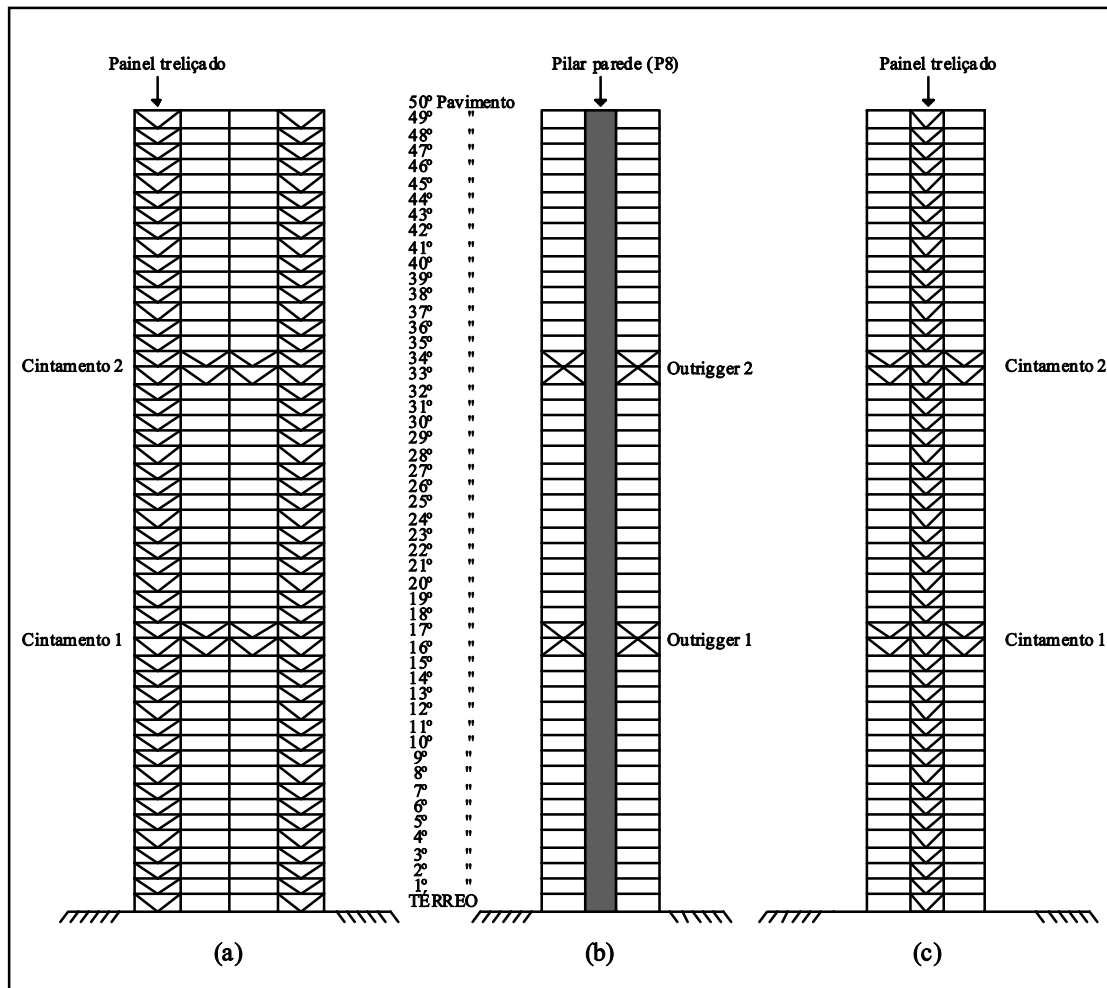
Vista frontal [Plano XZ] (a); Corte AA do modelo (b) e Vista lateral [Plano YZ] (c)
